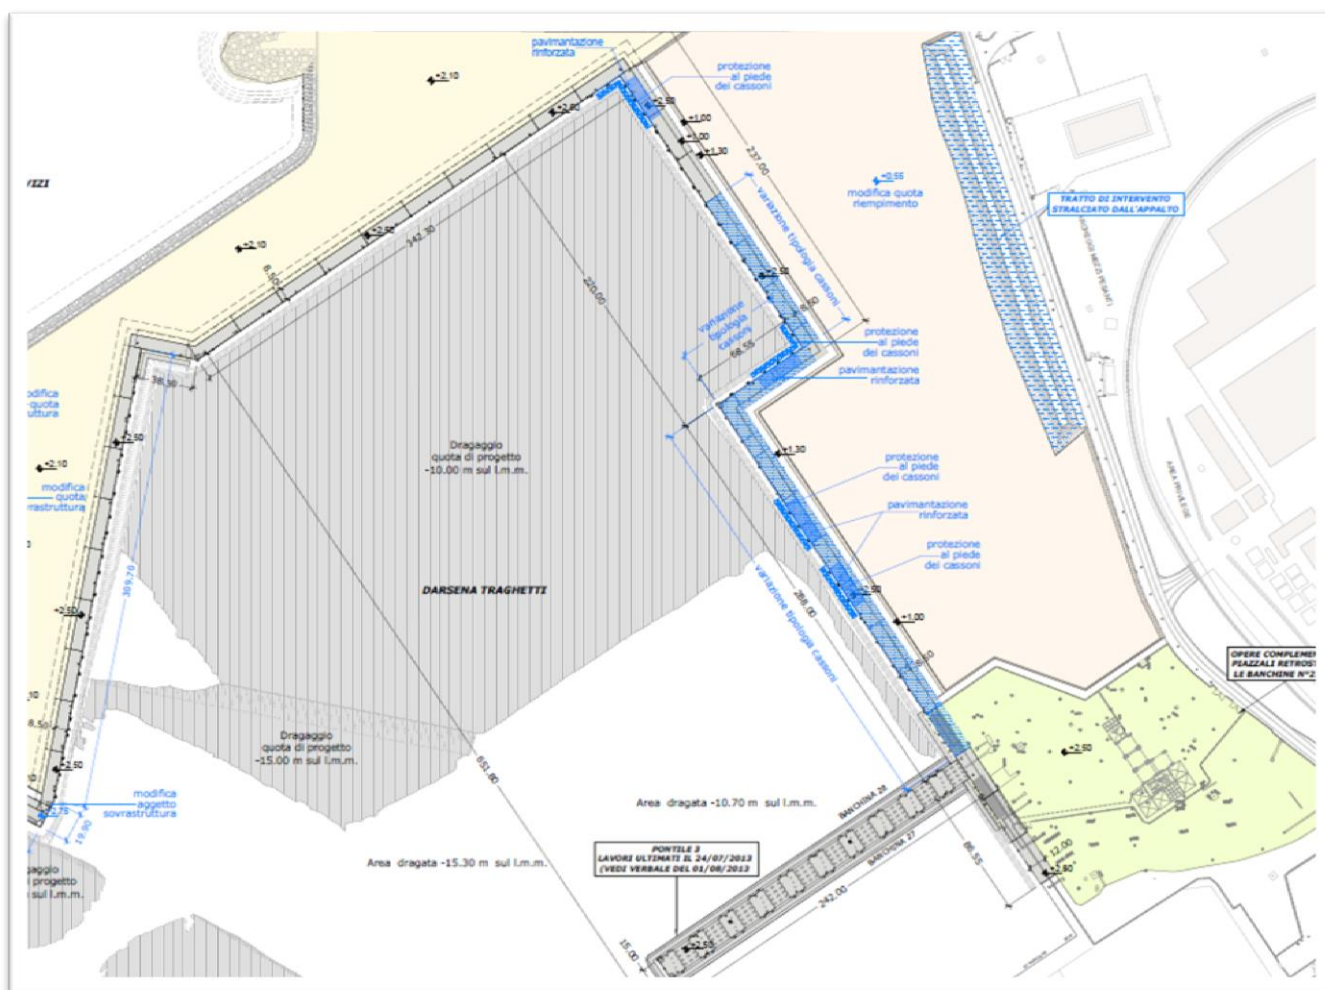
Stralcio planimetria di confronto 004 002 01AD
